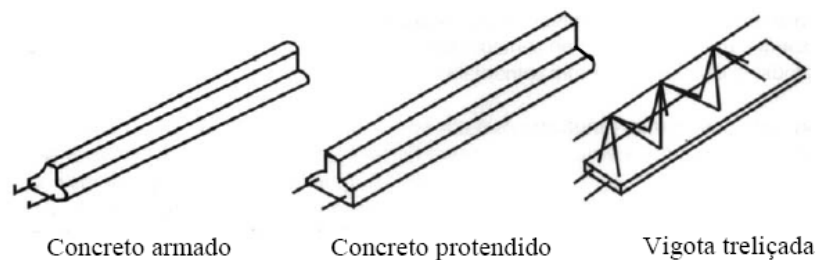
Tipos de vigotas pré-moldadas utilizadas nas lajes
